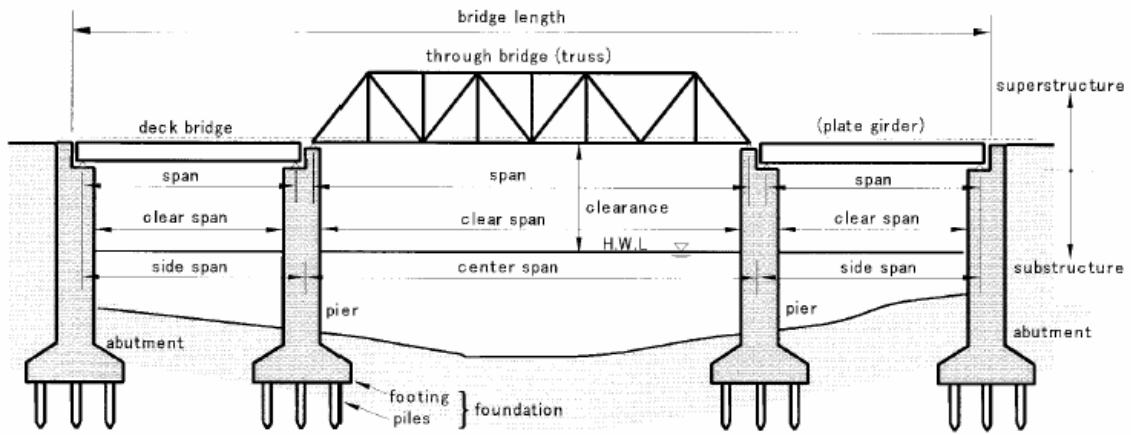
Köprü kirişleri (<http://www.prekastbeton.com.tr/faaliyetalanlari/kopru-kirisleri>)
